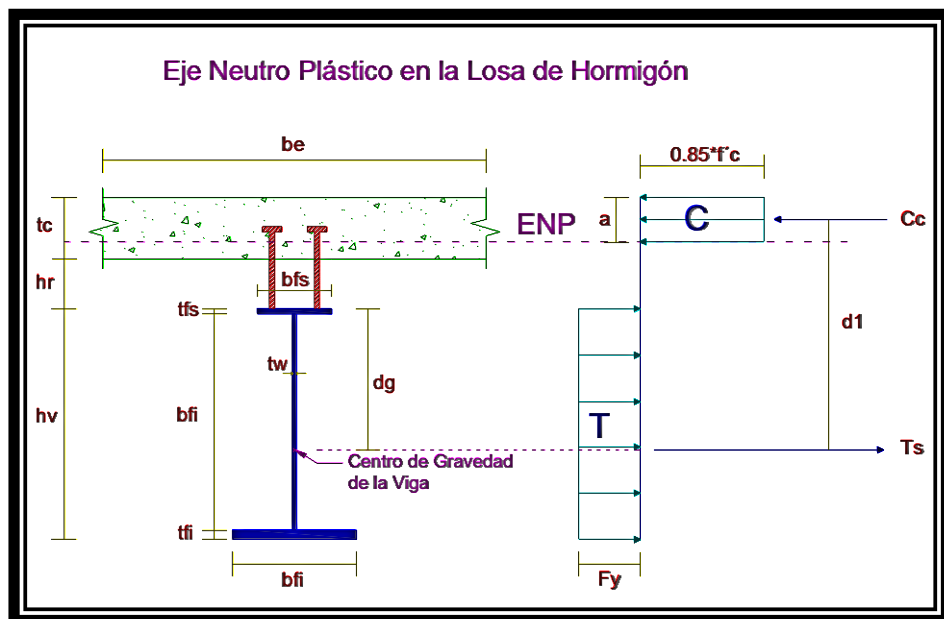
16: Distribución de esfuerzos cuando el Eje Neutro Plástico está en la Losa de Hormigón.
